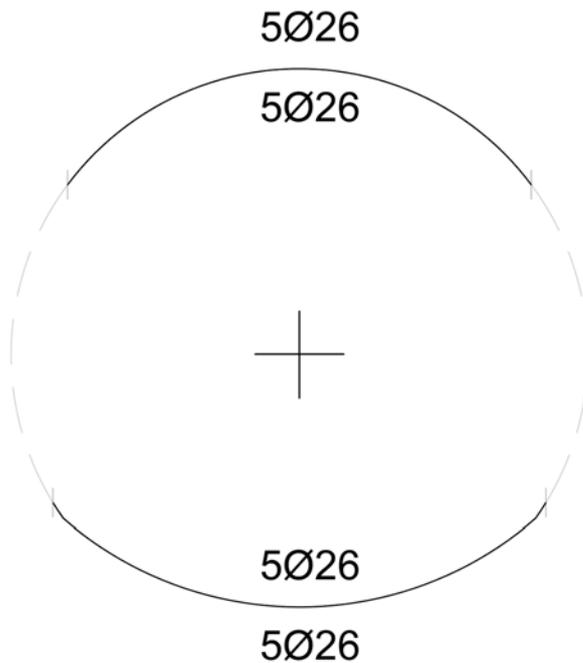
Sezione A-A3 e A-A4 – Armatura in direzione Y (trasversale)
